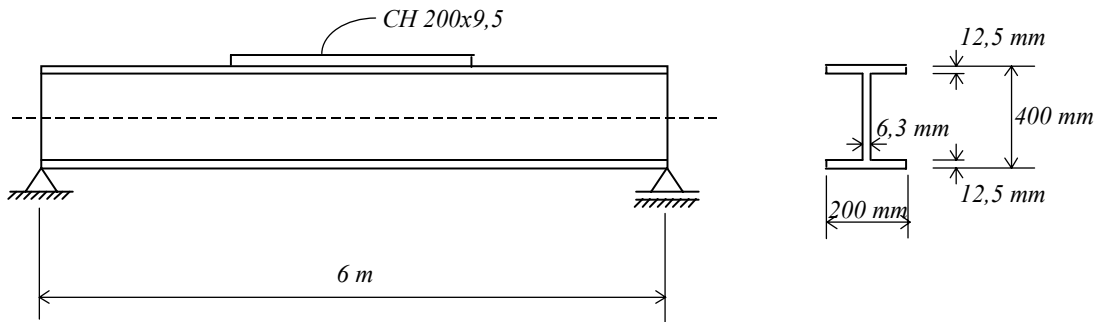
Vão da viga e seção transversal considerados na verificação de viga com lamela.
